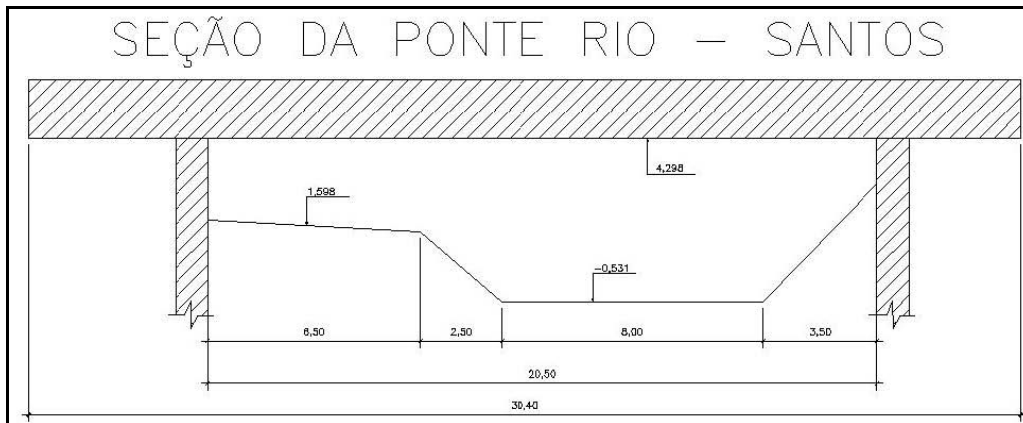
Corte esquemático da seção – Canal de São Fernando sob a ponte Rio -Santos
